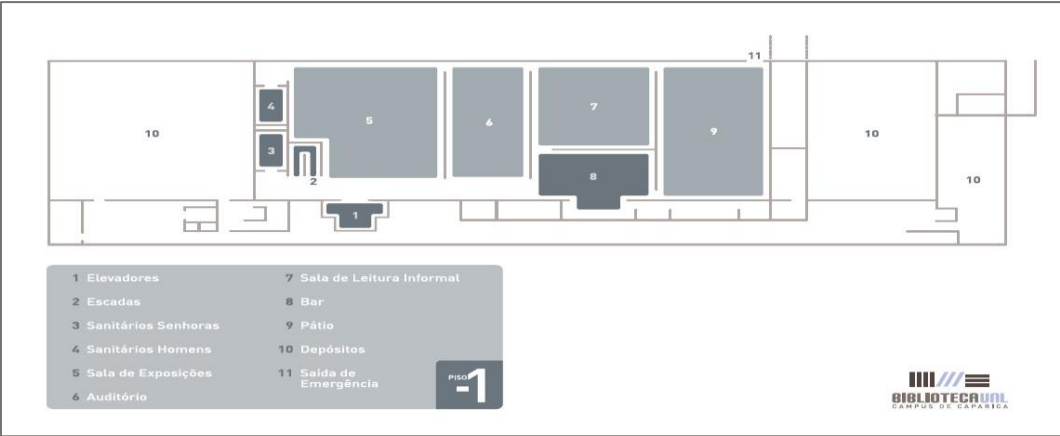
Planta do piso -1 (Edifício da Biblioteca FCT/UNL) [20]
